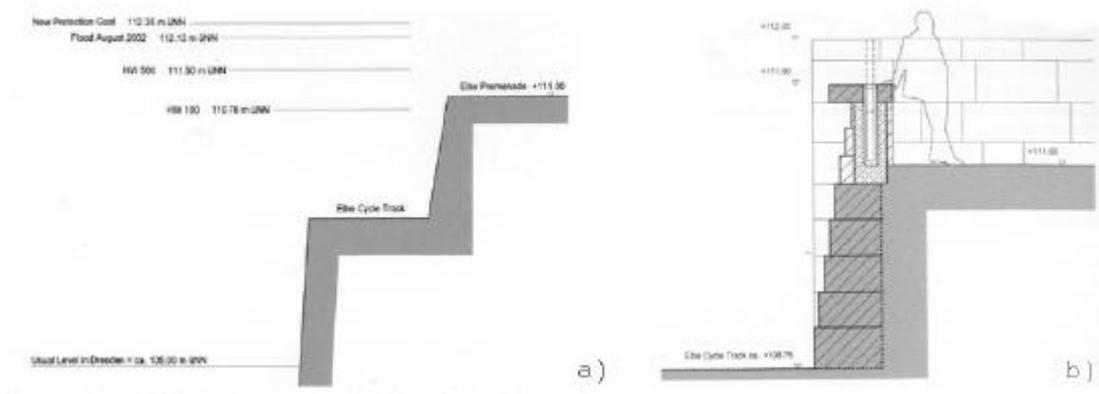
Sezione dei muri di protezione allo stato attuale (immagine a sinistra) e sezione di progetto (immagine a destra).
